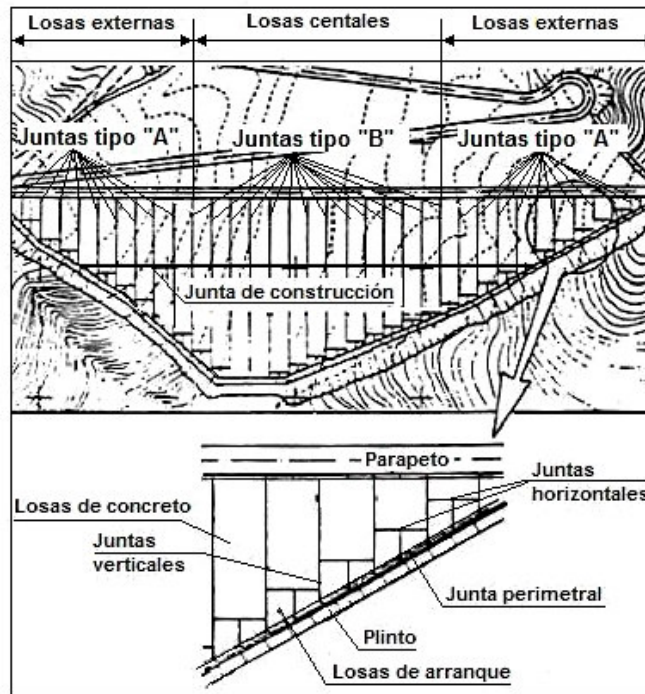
ESQUEMA DE LA LOSA DE CONCRETO DE LAS PRESAS DE ECC (WATERPOWER, 1990).
